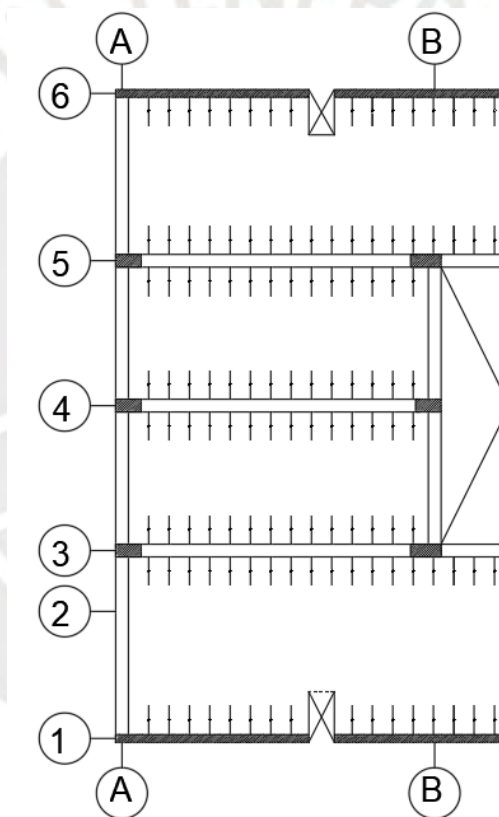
Sección de losa aligerada a diseñar
